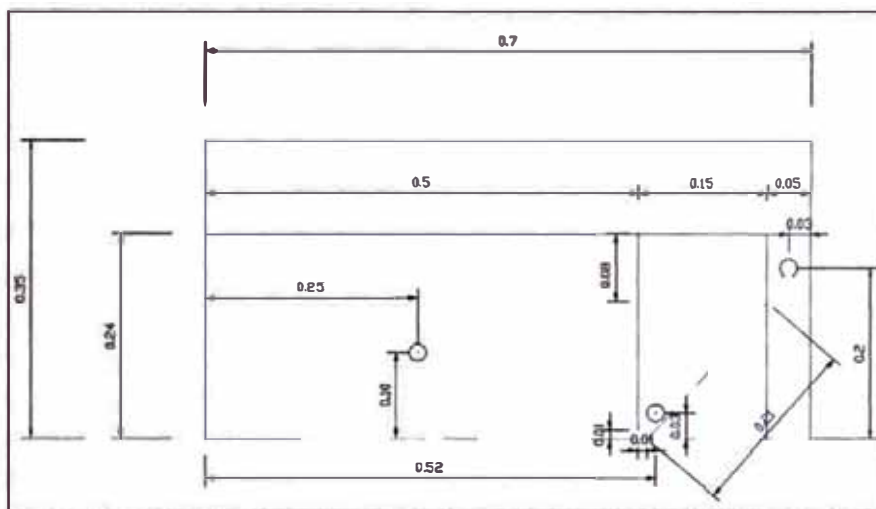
Corte Longitudinal de la Planta Piloto de Lodos Activados
